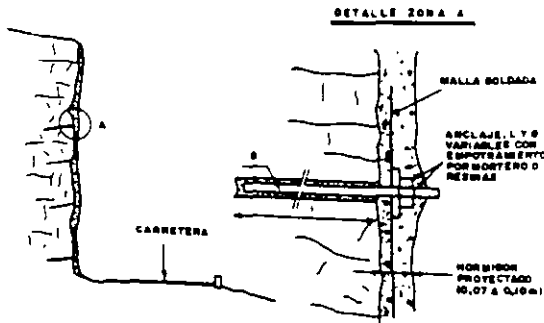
Protección por revestimiento de hormigón proyectado.
